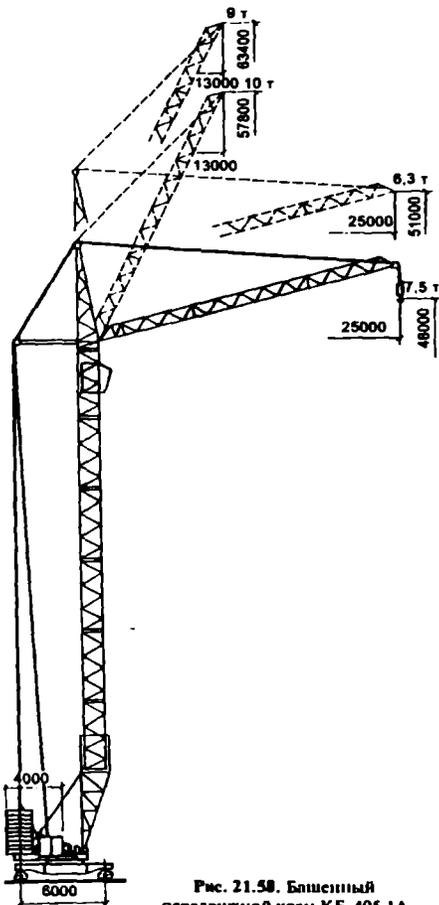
Башенный передвижной кран КБ-405.1А
